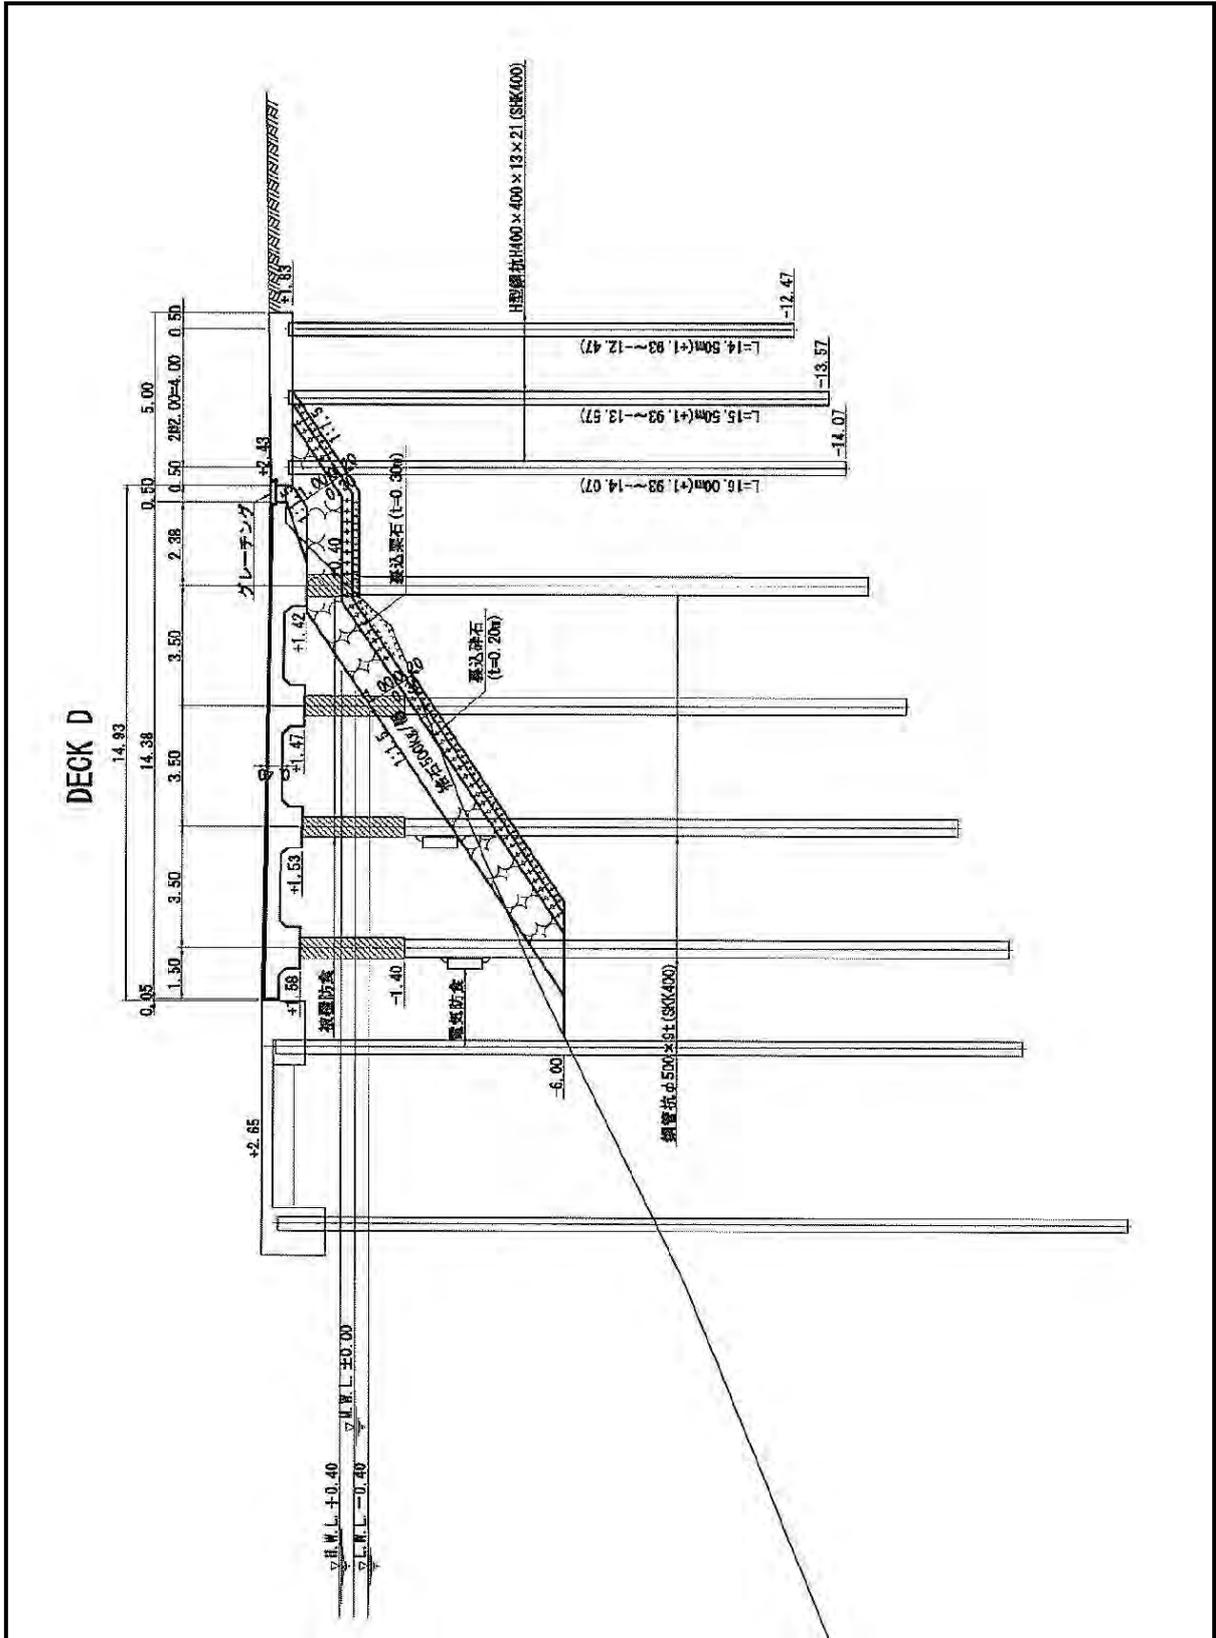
コンクリートデッキ 断面図 (西端部)
